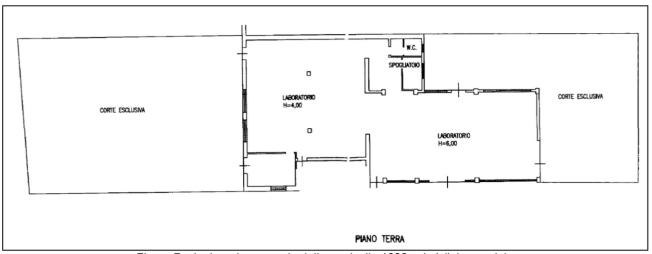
planimetria catastale della particella 1222 sub 1 (laboratorio)
